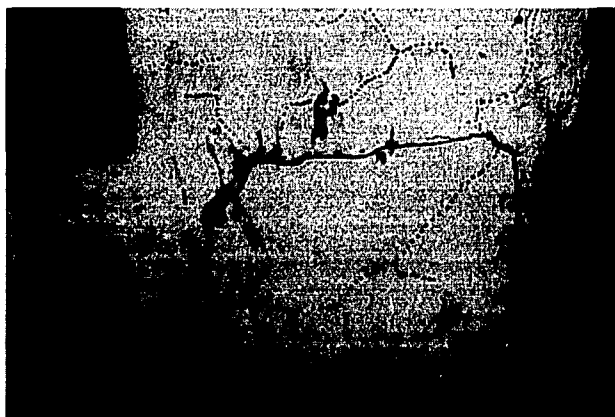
Casa 7, agrietamiento en un muro exterior
